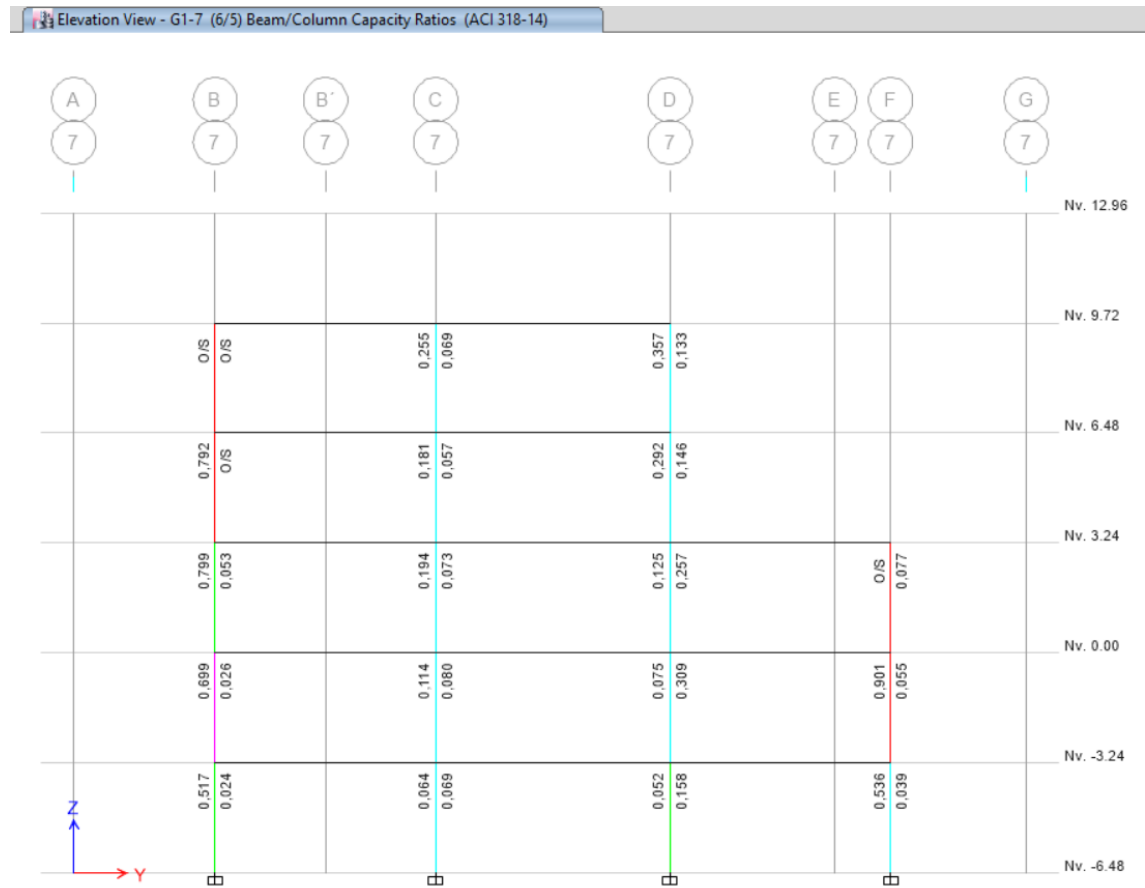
Vista en elevación de factor de capacidad unión viga-columnas, pórtico eje 6.
